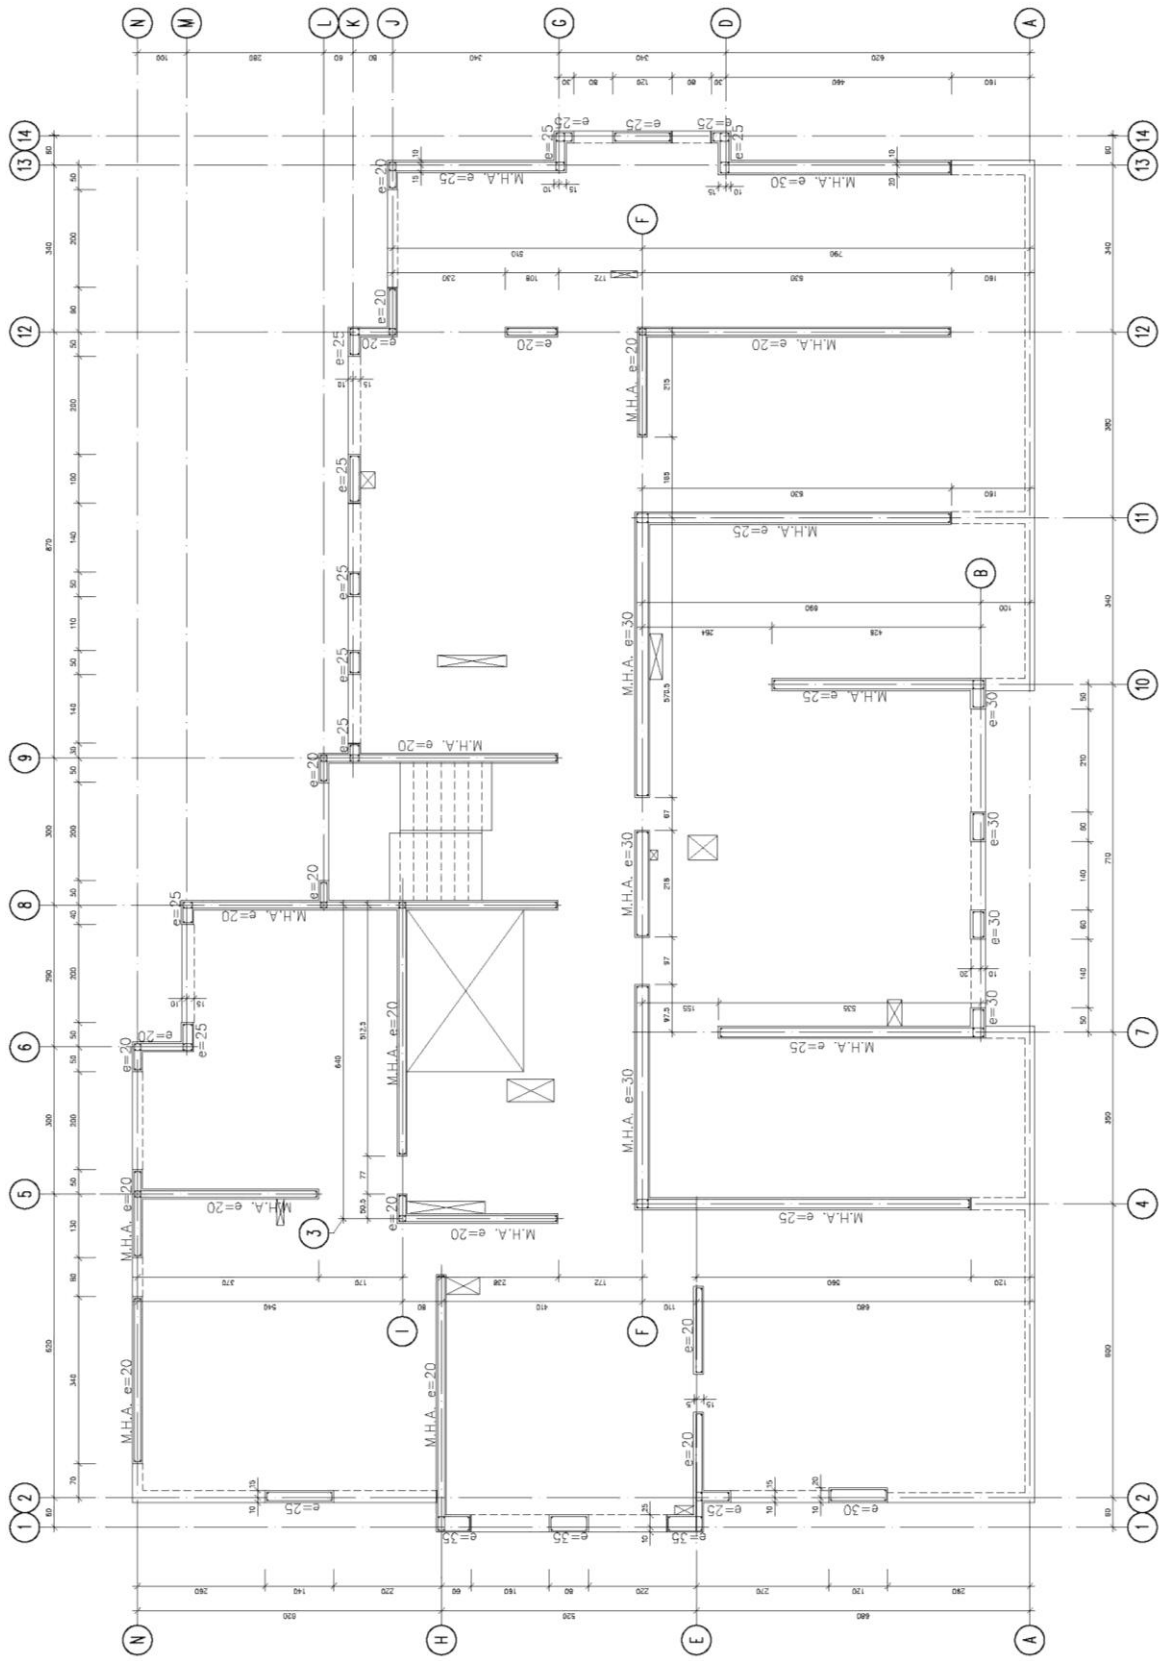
Planta de estructura cielo 4° piso a 6° piso
